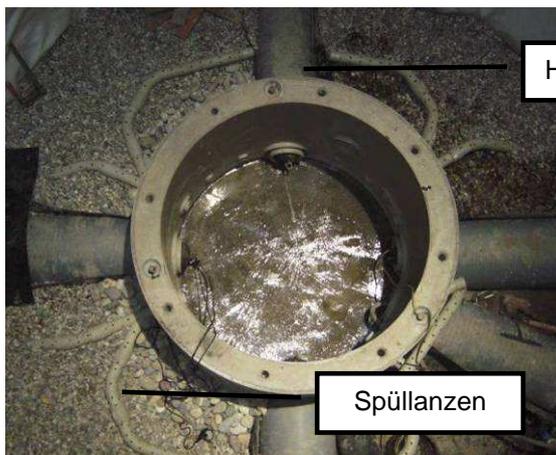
Schachtunterteil (Drainageschacht) mit Hüllrohren und Spüllanzen
